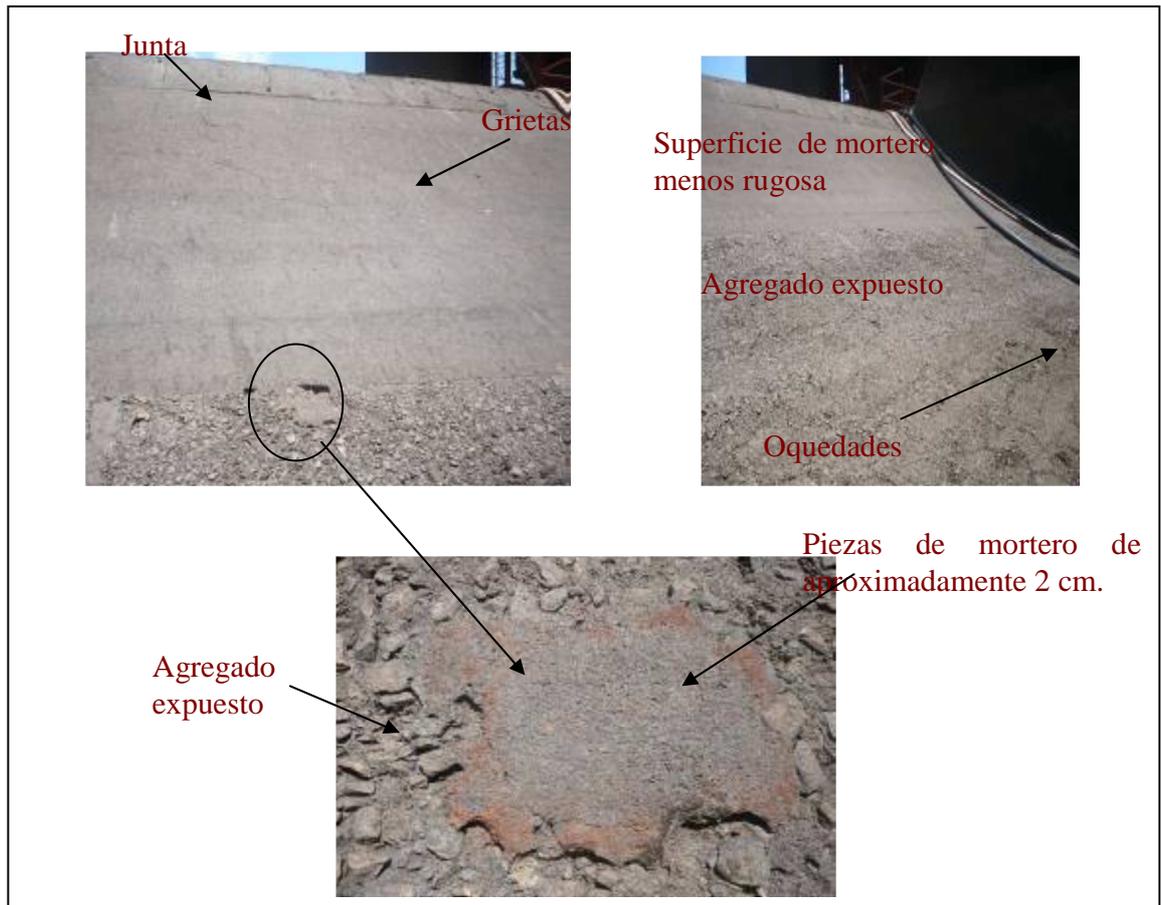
Daños en la superficie de concreto del lanzador. (Autor, 2009).
